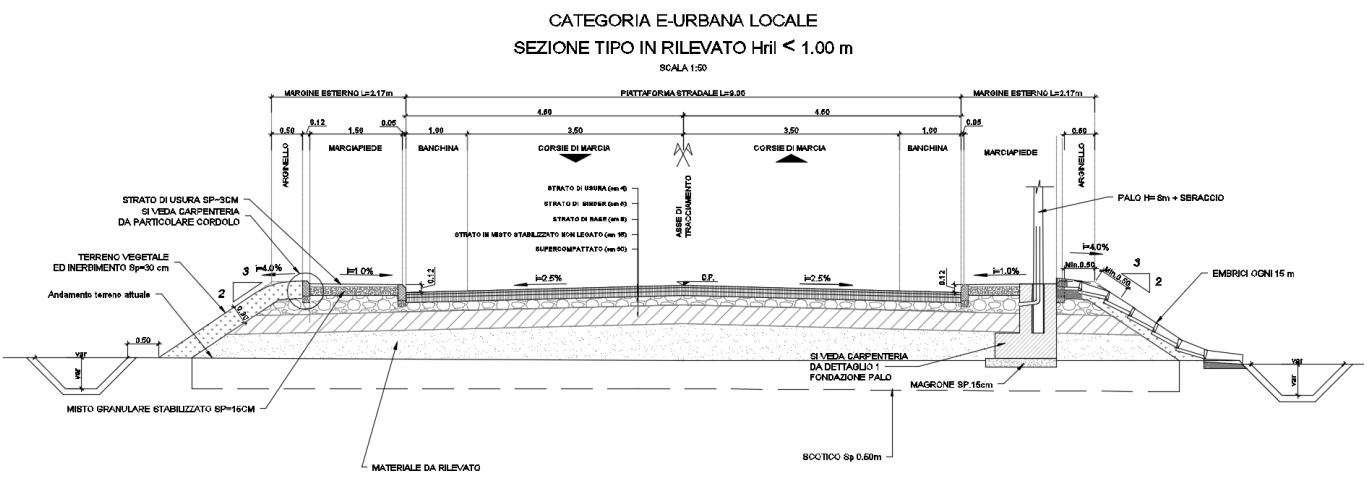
Asse 4 – Sezione tipo in rilevato H_{ri} ≤ 1m
